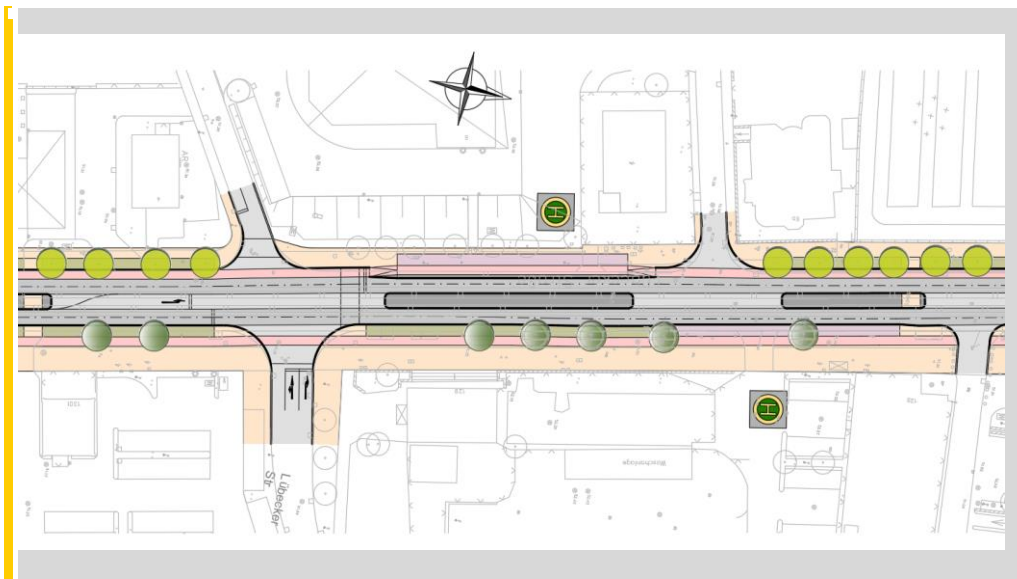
Lübecker Straße Süd, Lageplanausschnitt V3
